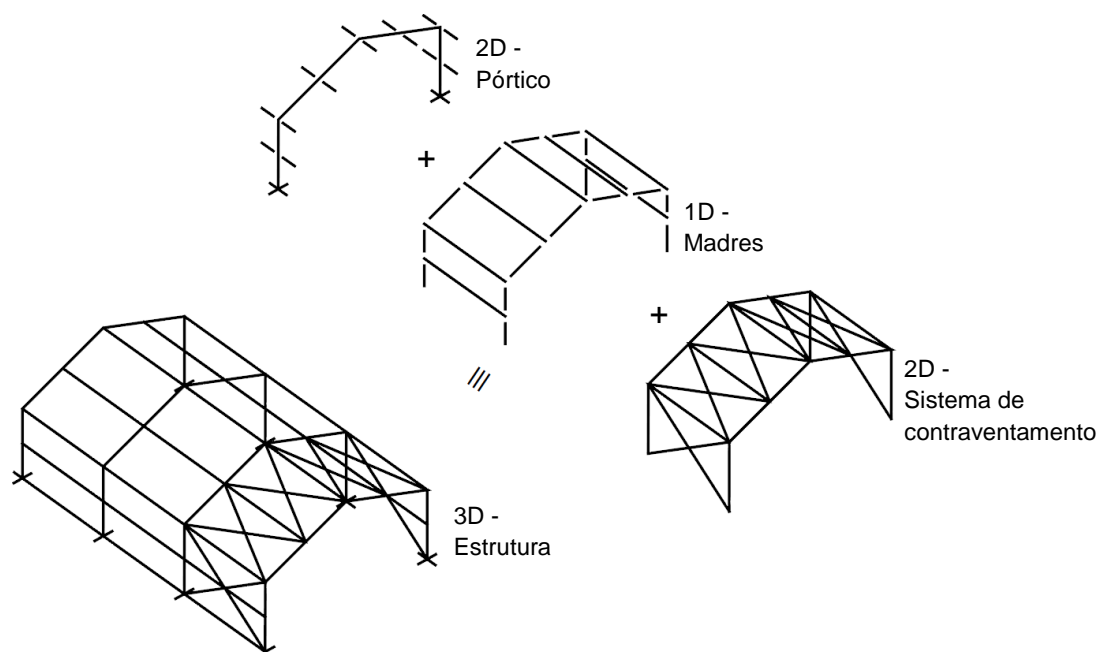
Simplificação de um pavilhão metálico 3D para formas mais simples (adaptado de Trahair *et al.*, 2008)
